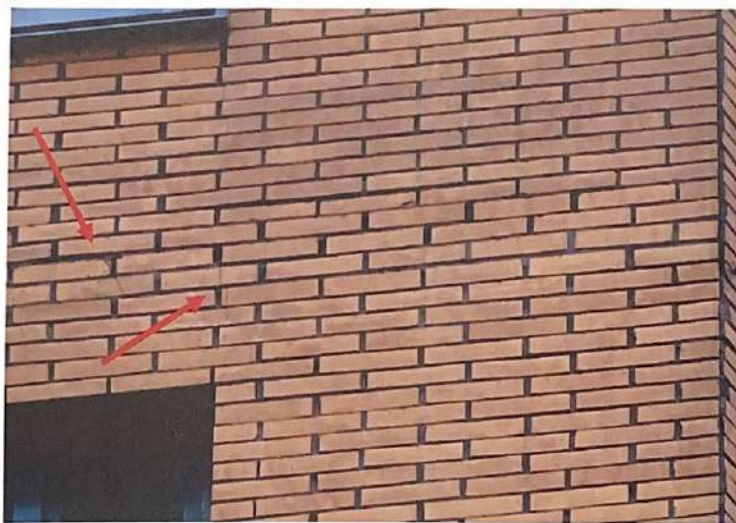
Секция 11. Ось E13. Пустошовка по облицовке торца плит перекрытия.
